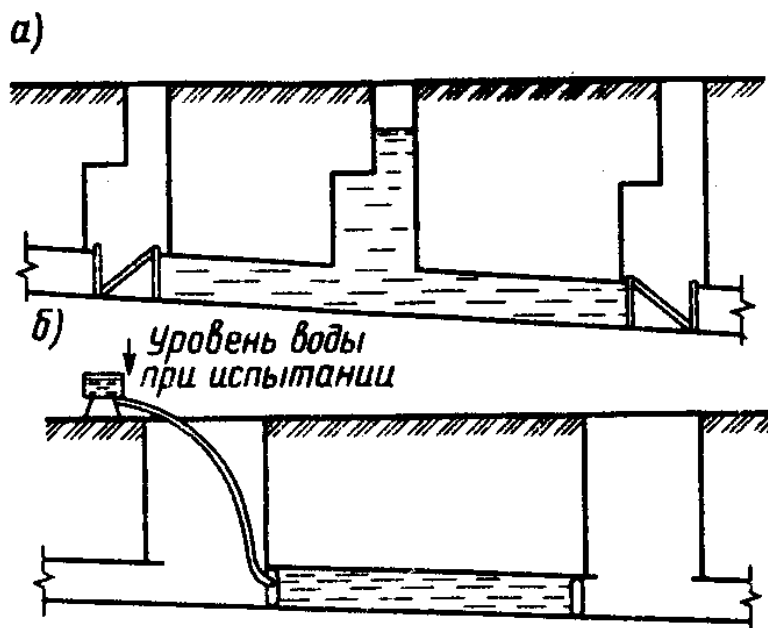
Схема гидравлических испытаний канализационных трубопроводов на утечку воды:
